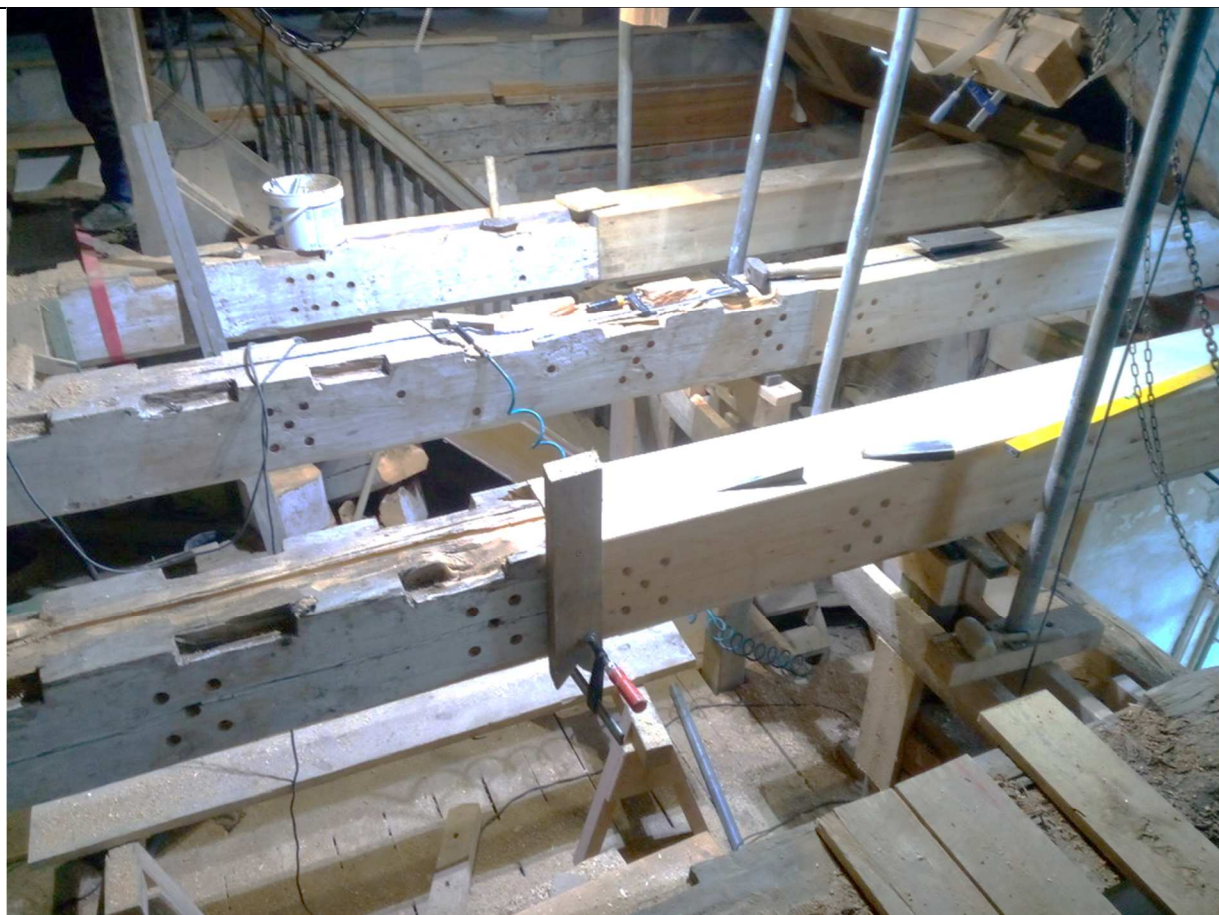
Belka o pilokształtnym profilu nad помещением 1.09 – rzut poziomy i widok
